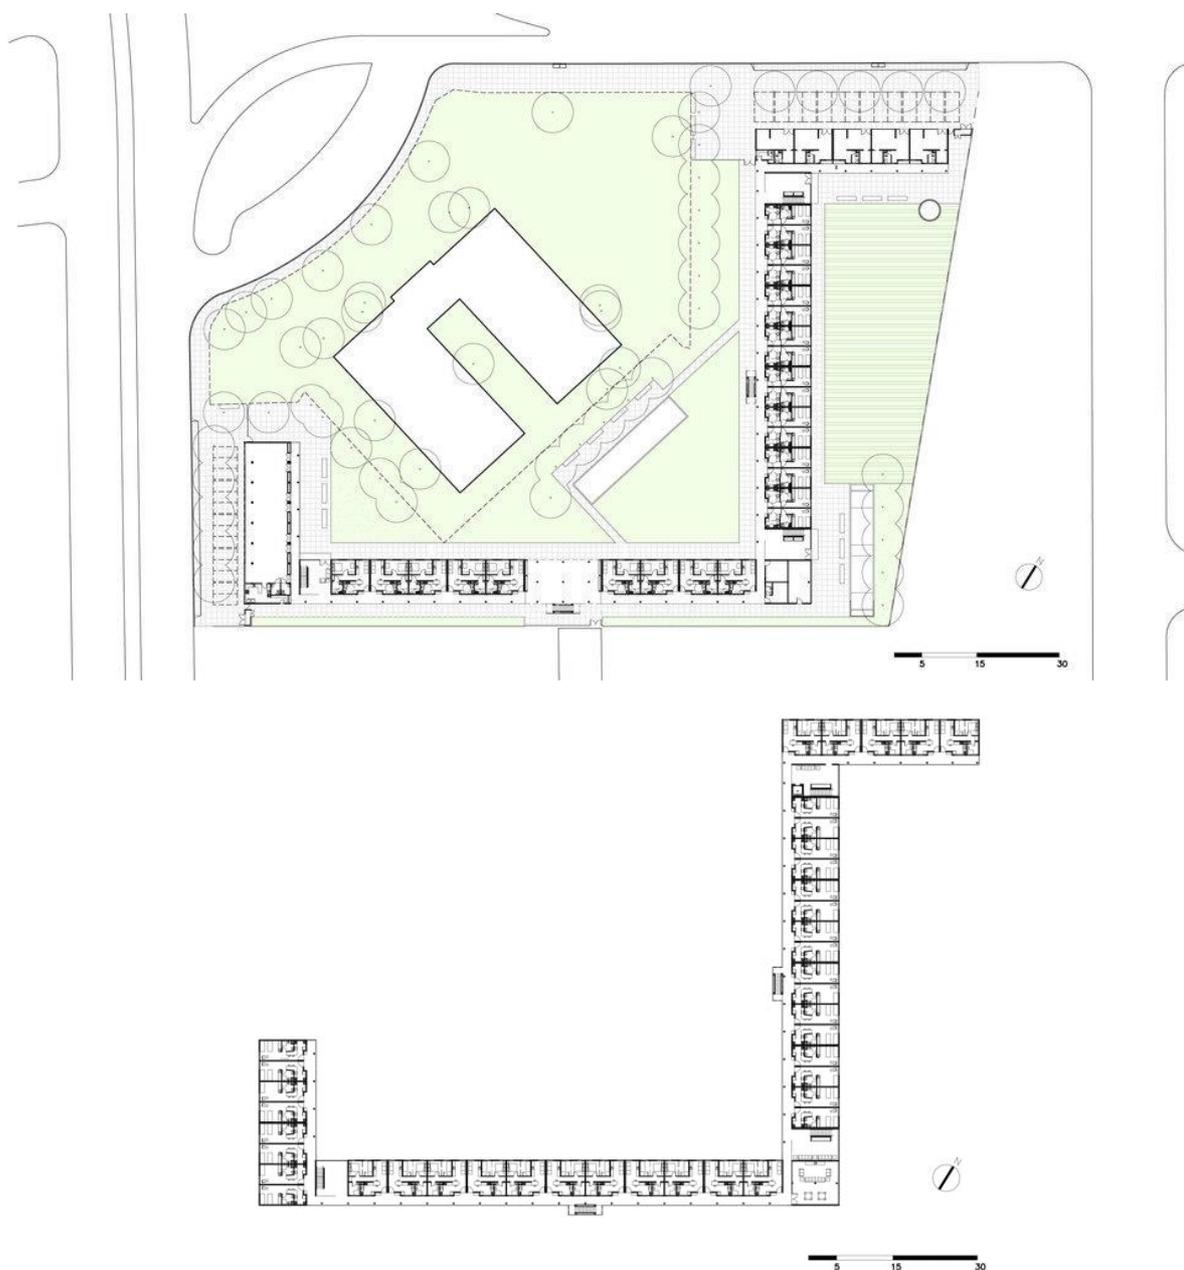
Planta do pavimento térreo e pavimento tipo da Vila dos Idosos
